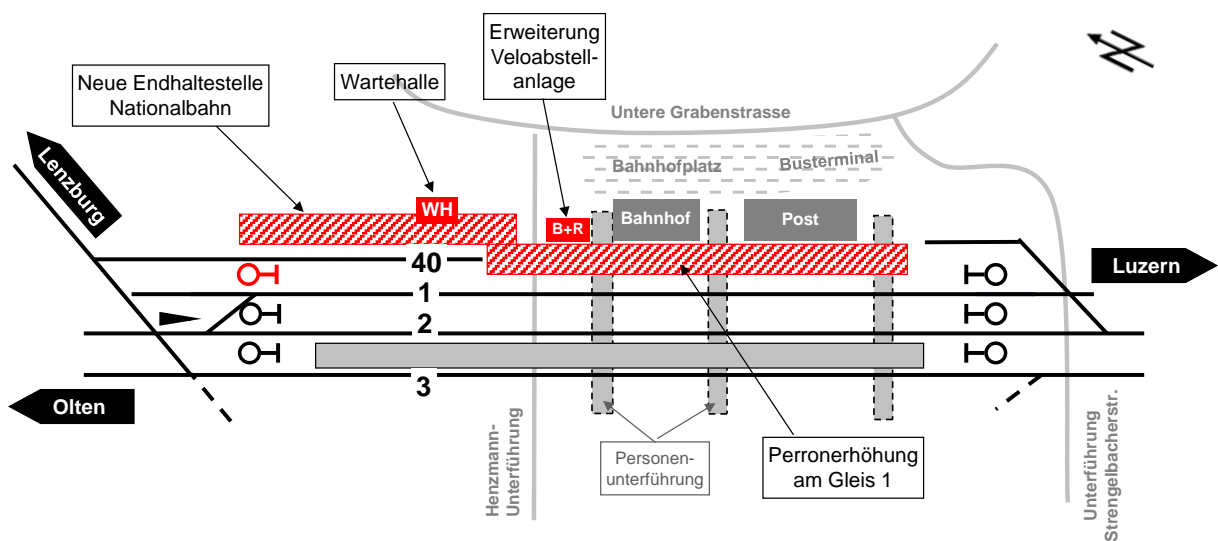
Schematischer Situationsplan Bahnhof Zofingen
